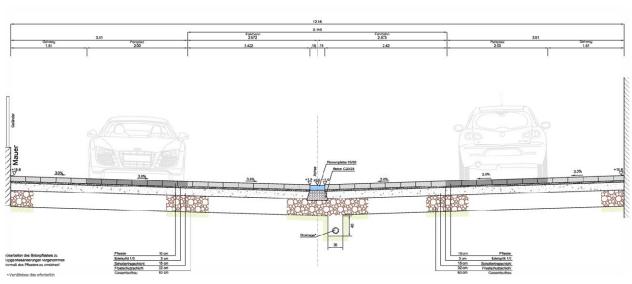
Pflasterflächen Rheinstraße, Regelquerschnitt
